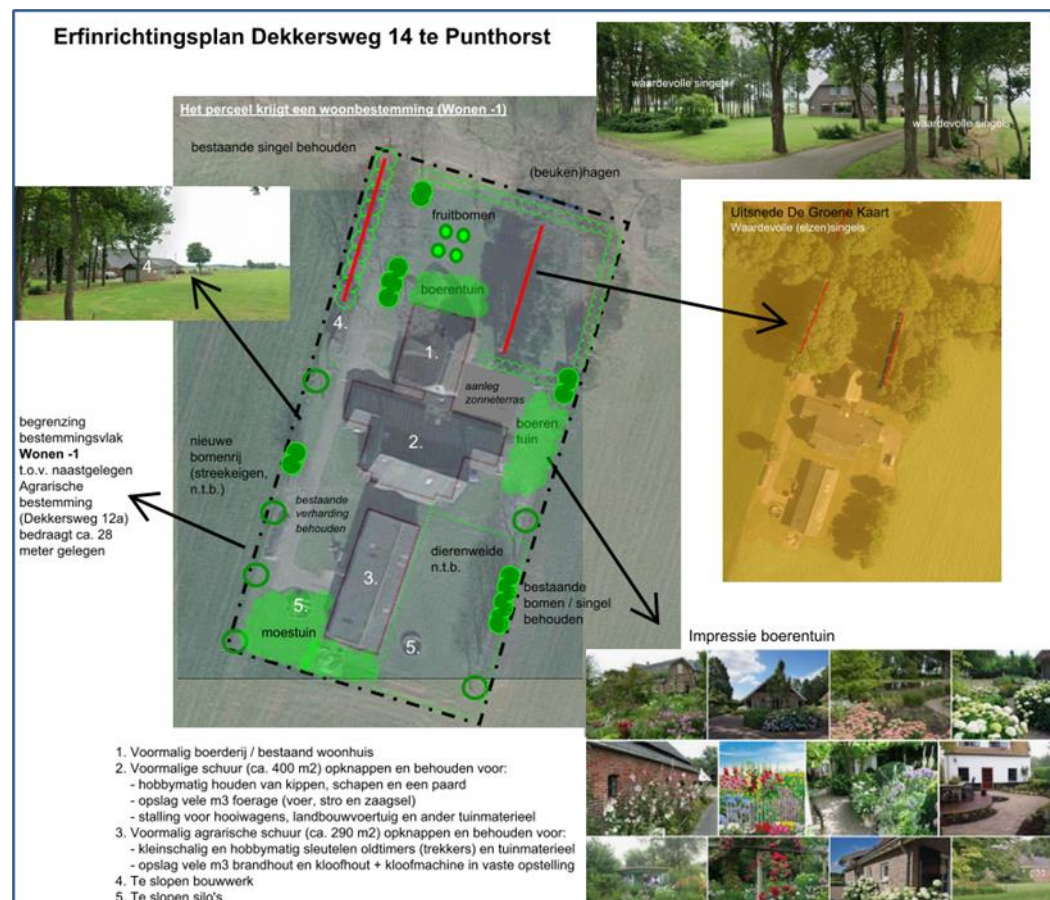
Een weergave van het erfinrichtingsplan van het plangebied.
